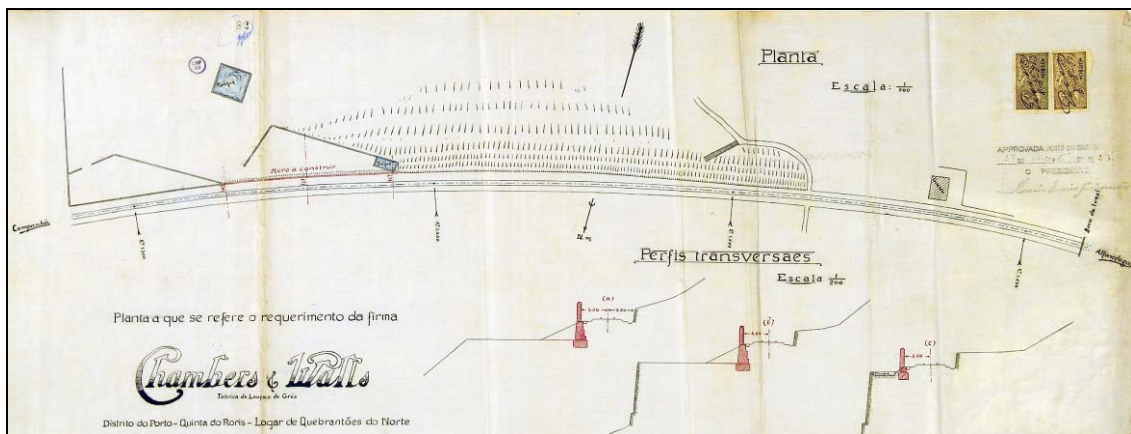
Planta do muro a construir para conclusão da vedação da Quinta do Roriz.
